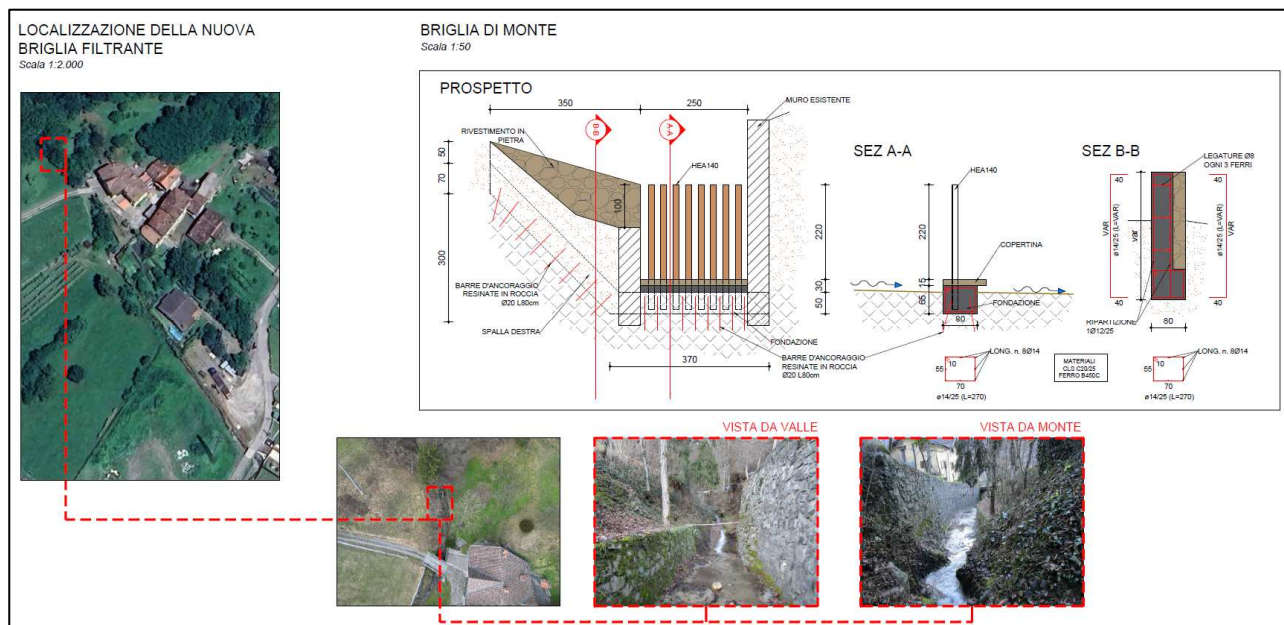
Stralcio della planimetria di progetto e della briglia di monte.
